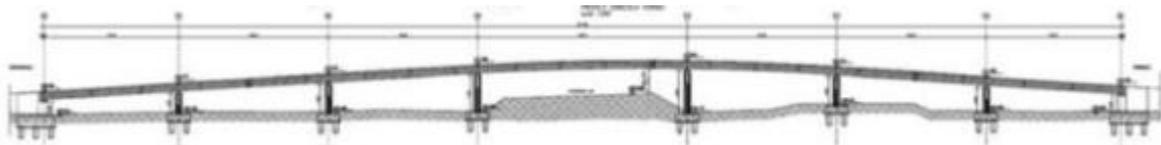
Sovrappasso di ingresso- profilo longitudinale
